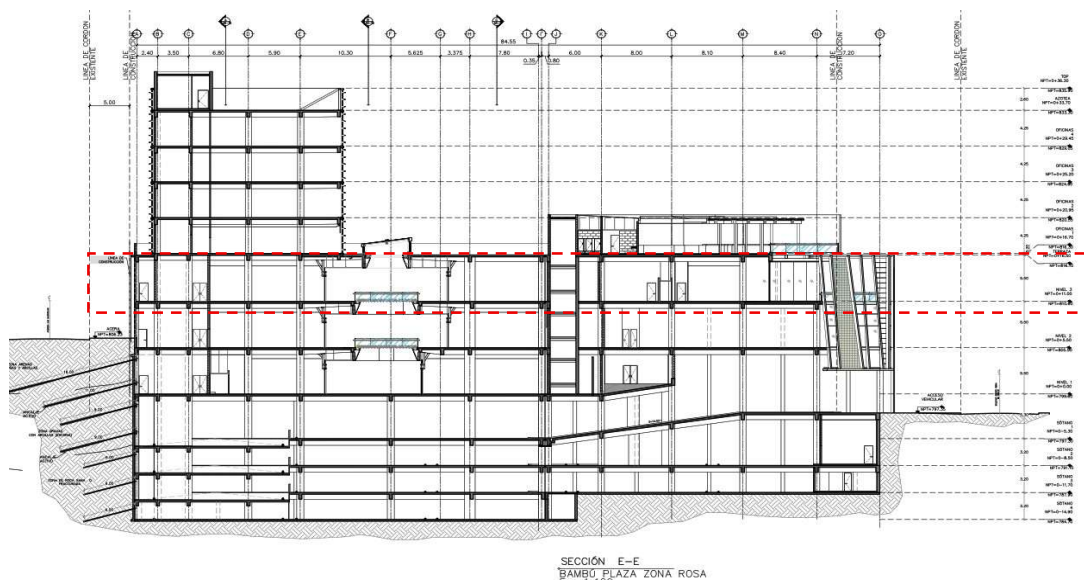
Plano Sección EE, Fuente: Elaboración Centro Comercial Bambú.
